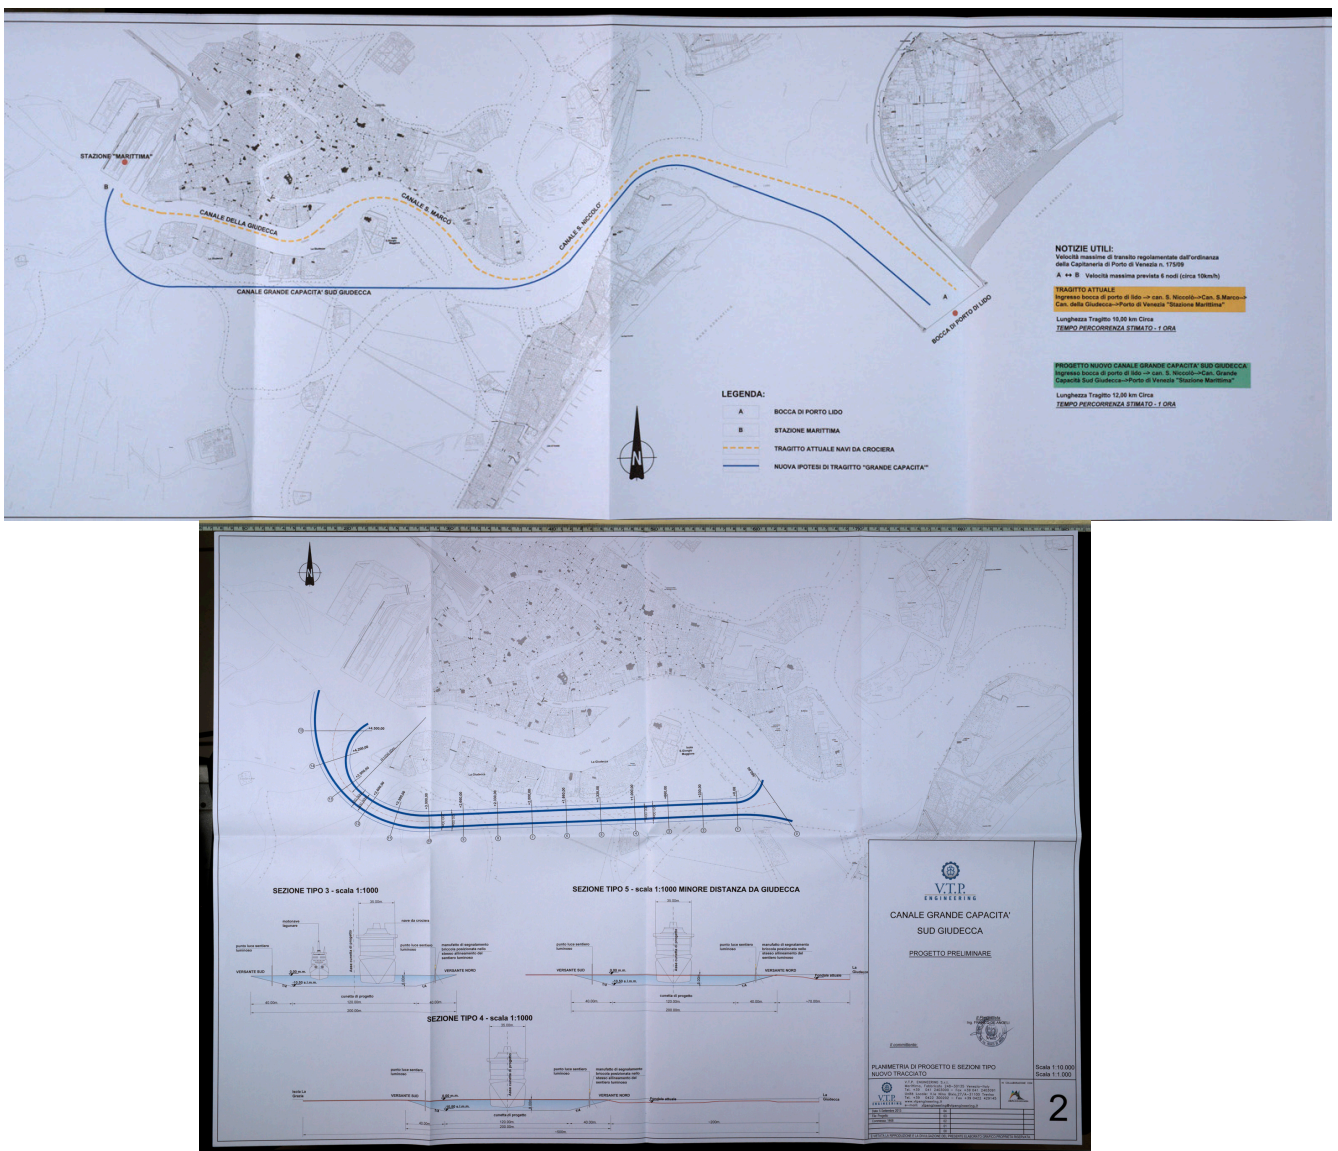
Planimetria d'insieme e sezioni tipo.
